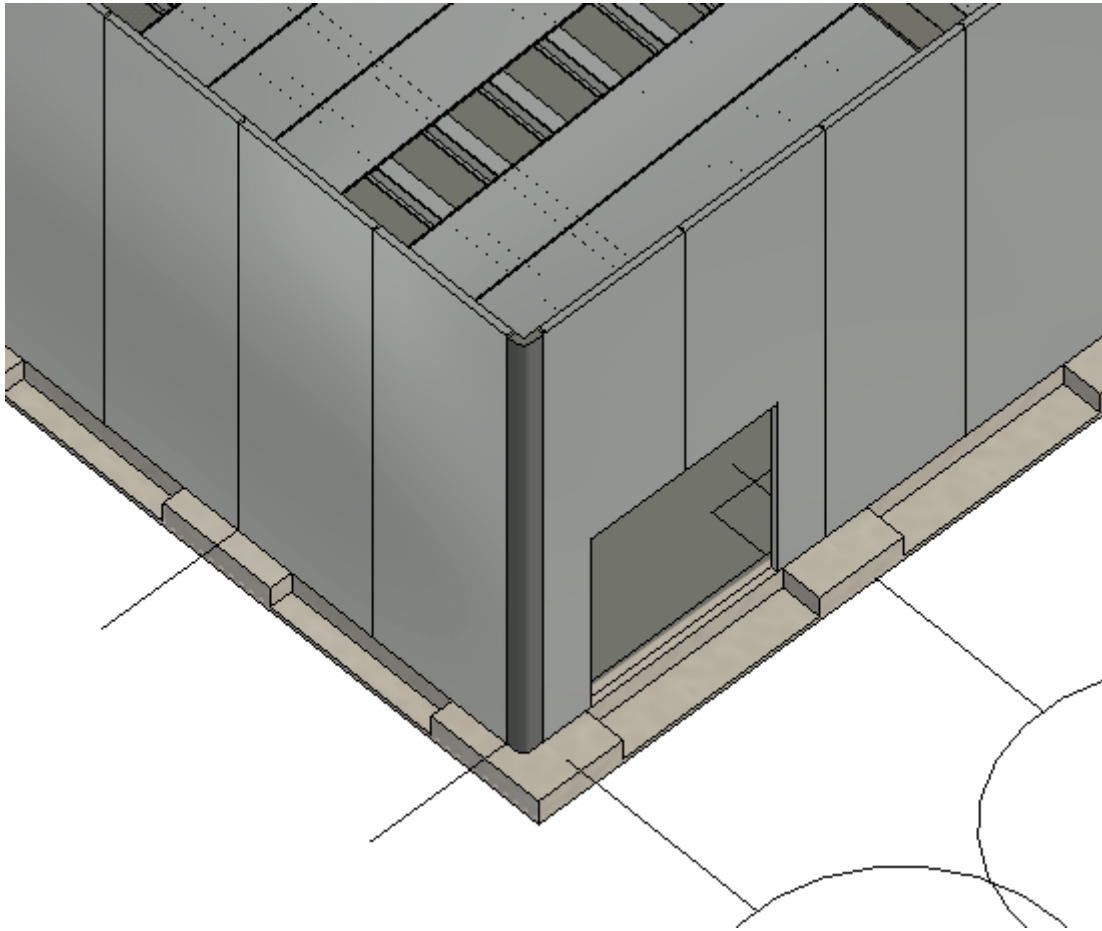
Detall unions amb de les cantonades amb els panells verticals. (Font: "Revit")
